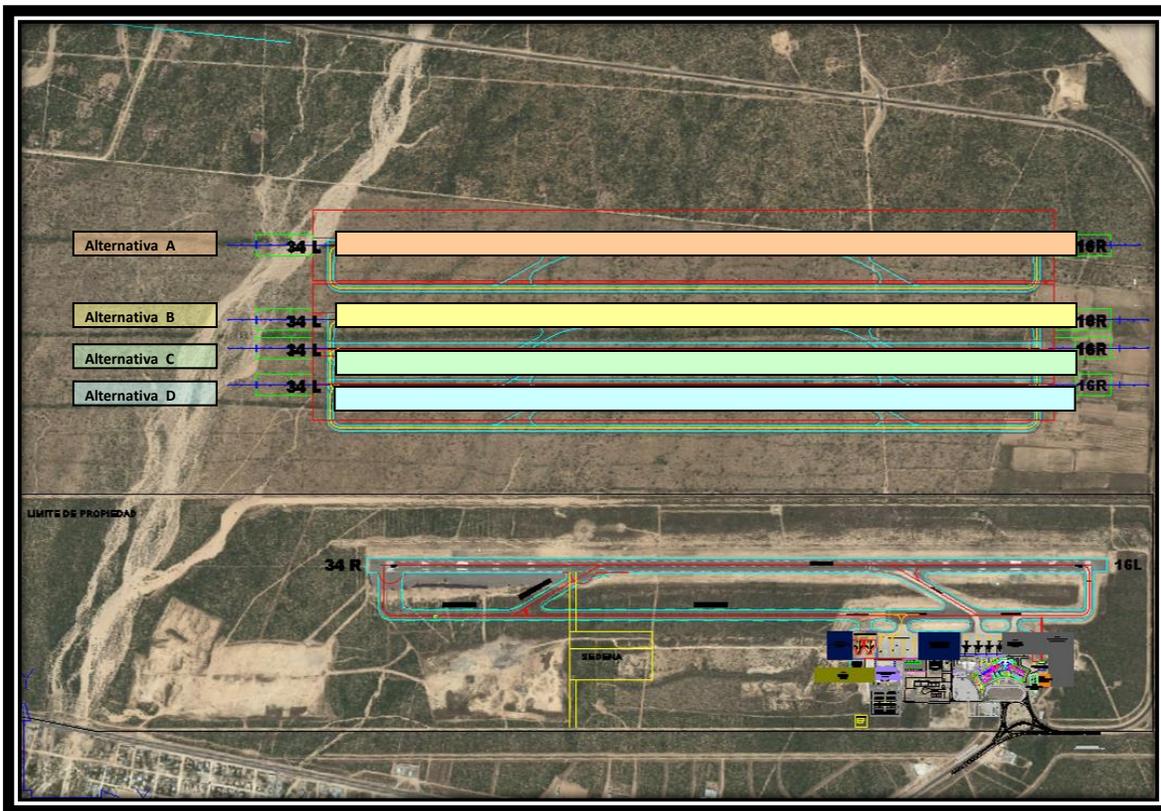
Vista de las Alternativas consideradas para la Nueva Pista
